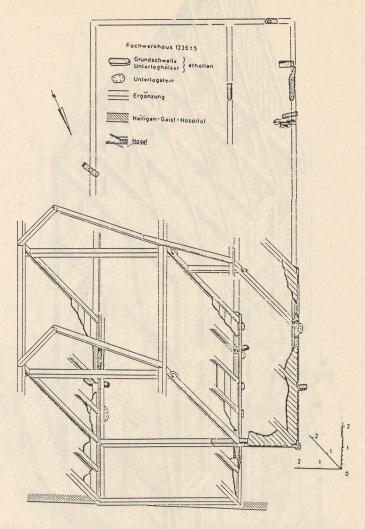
Hansestadt Lübeck, Fachwerkbau unter dem Heiligen-Geist-Hospital an der Großen Gröpelgrube, um 1236. Grundriß mit Rekonstruktionsversuch (nach Fehring 1986).
